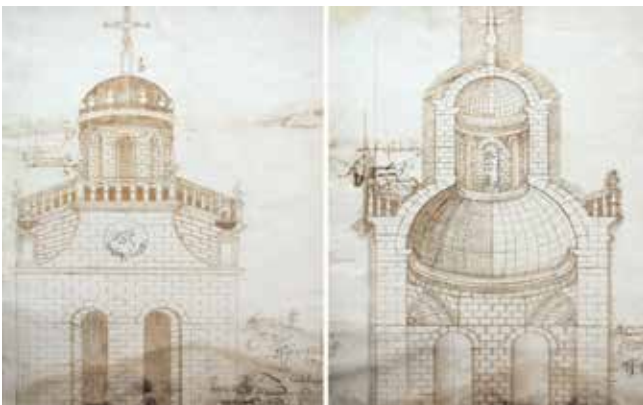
Diseño del alzado y de la planta de la torre de las campanas realizadas por Gaspar de Arce en 1575¹⁸.
